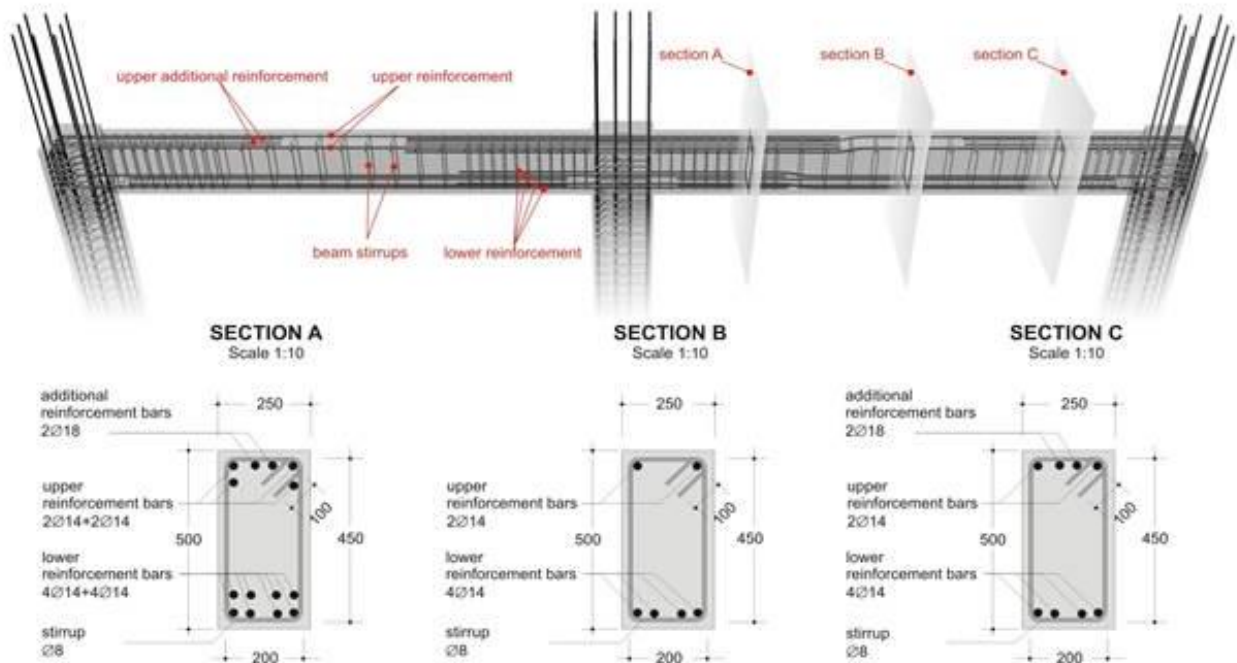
Viga Continua de Hormigón: pórticos. Armado general y detalle de secciones
